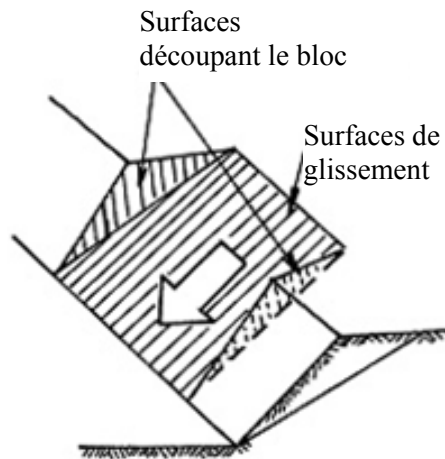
Glissement plan (Hoek et Bray, 1977)
